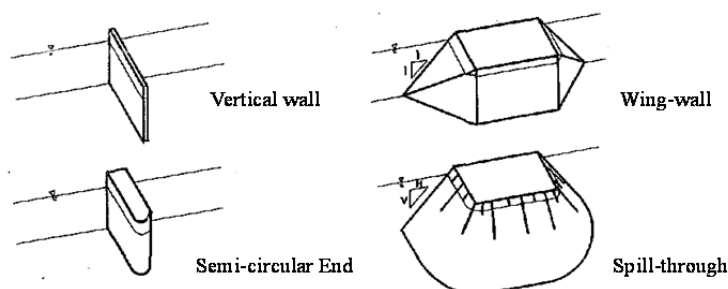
代表的な abutment, 水制工の形状 (Melville¹⁴⁾)
